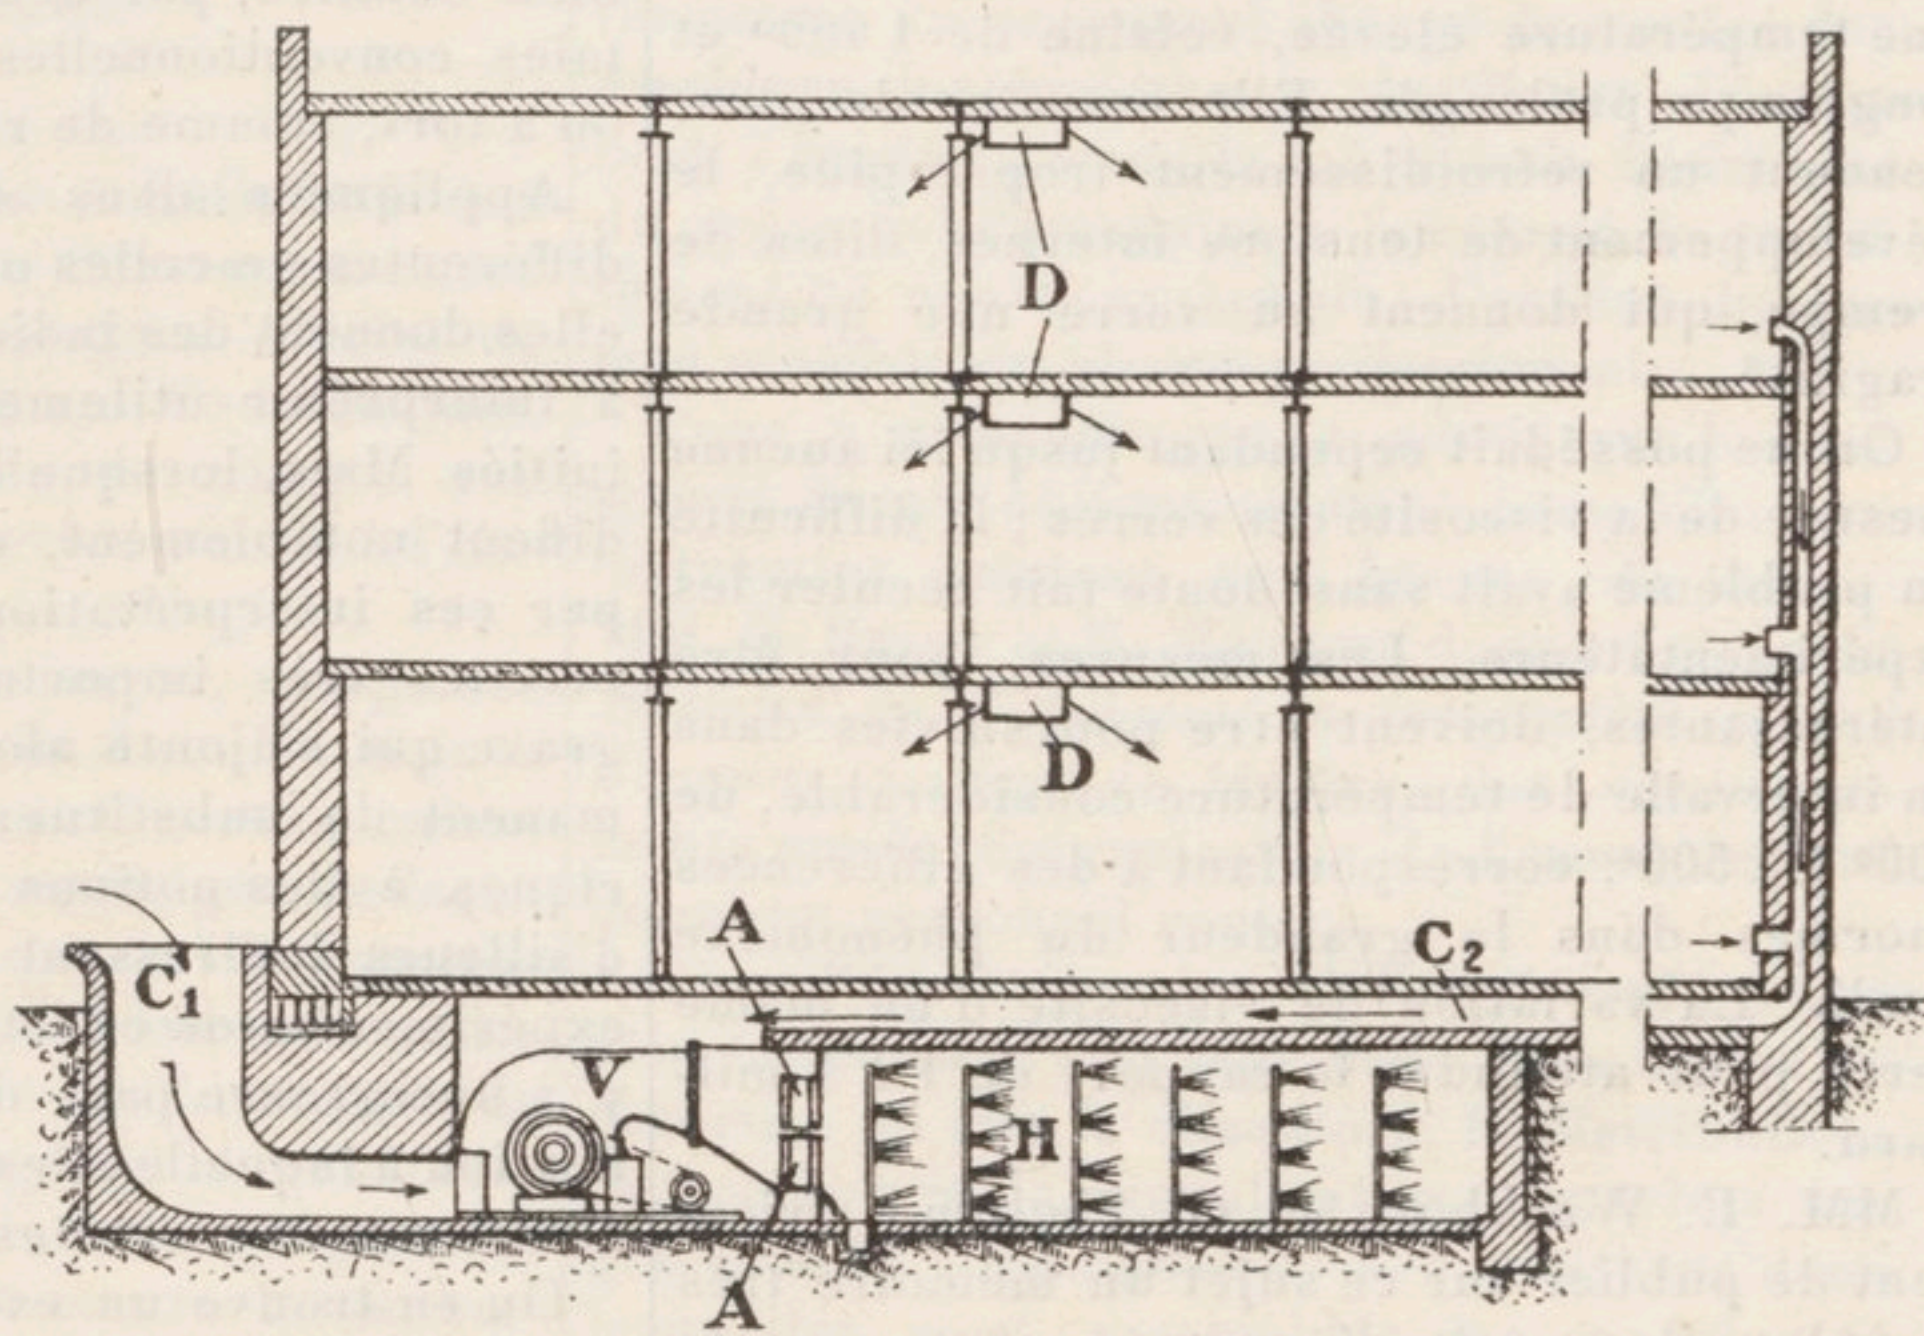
Coupe schématique d'une installation de ventilation et d'humidification d'un atelier textile.
